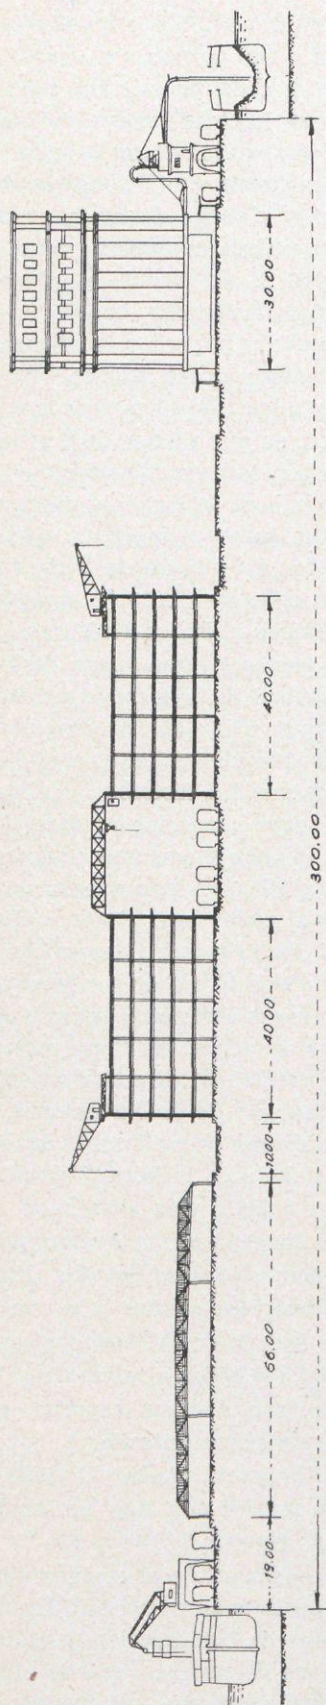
ª—Sección transversal del espigón entre las dársenas I y II.
